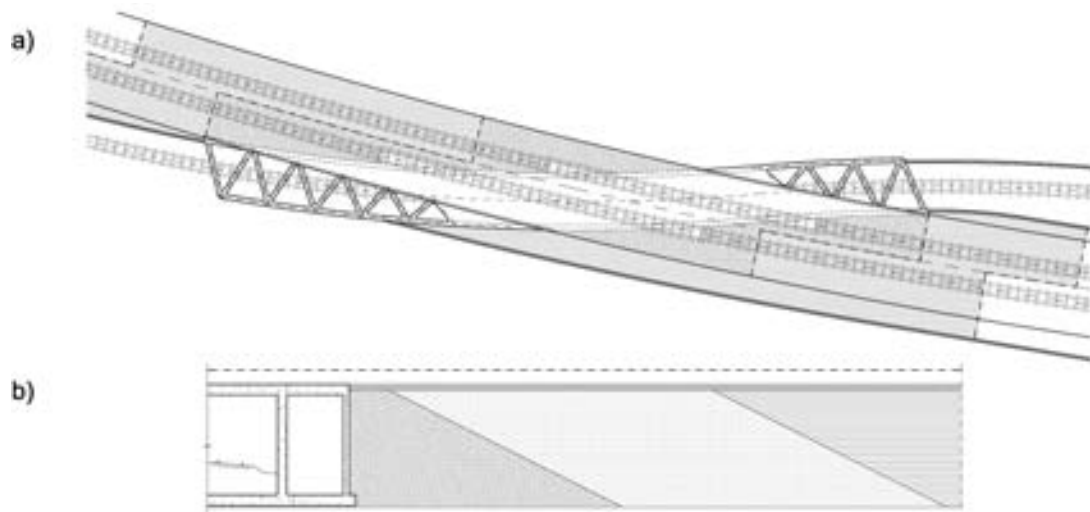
Cuñas de transición en la pérgola en la L.A.V. Córdoba-Málaga en Málaga; a) Planta; b) Sección longitudinal
